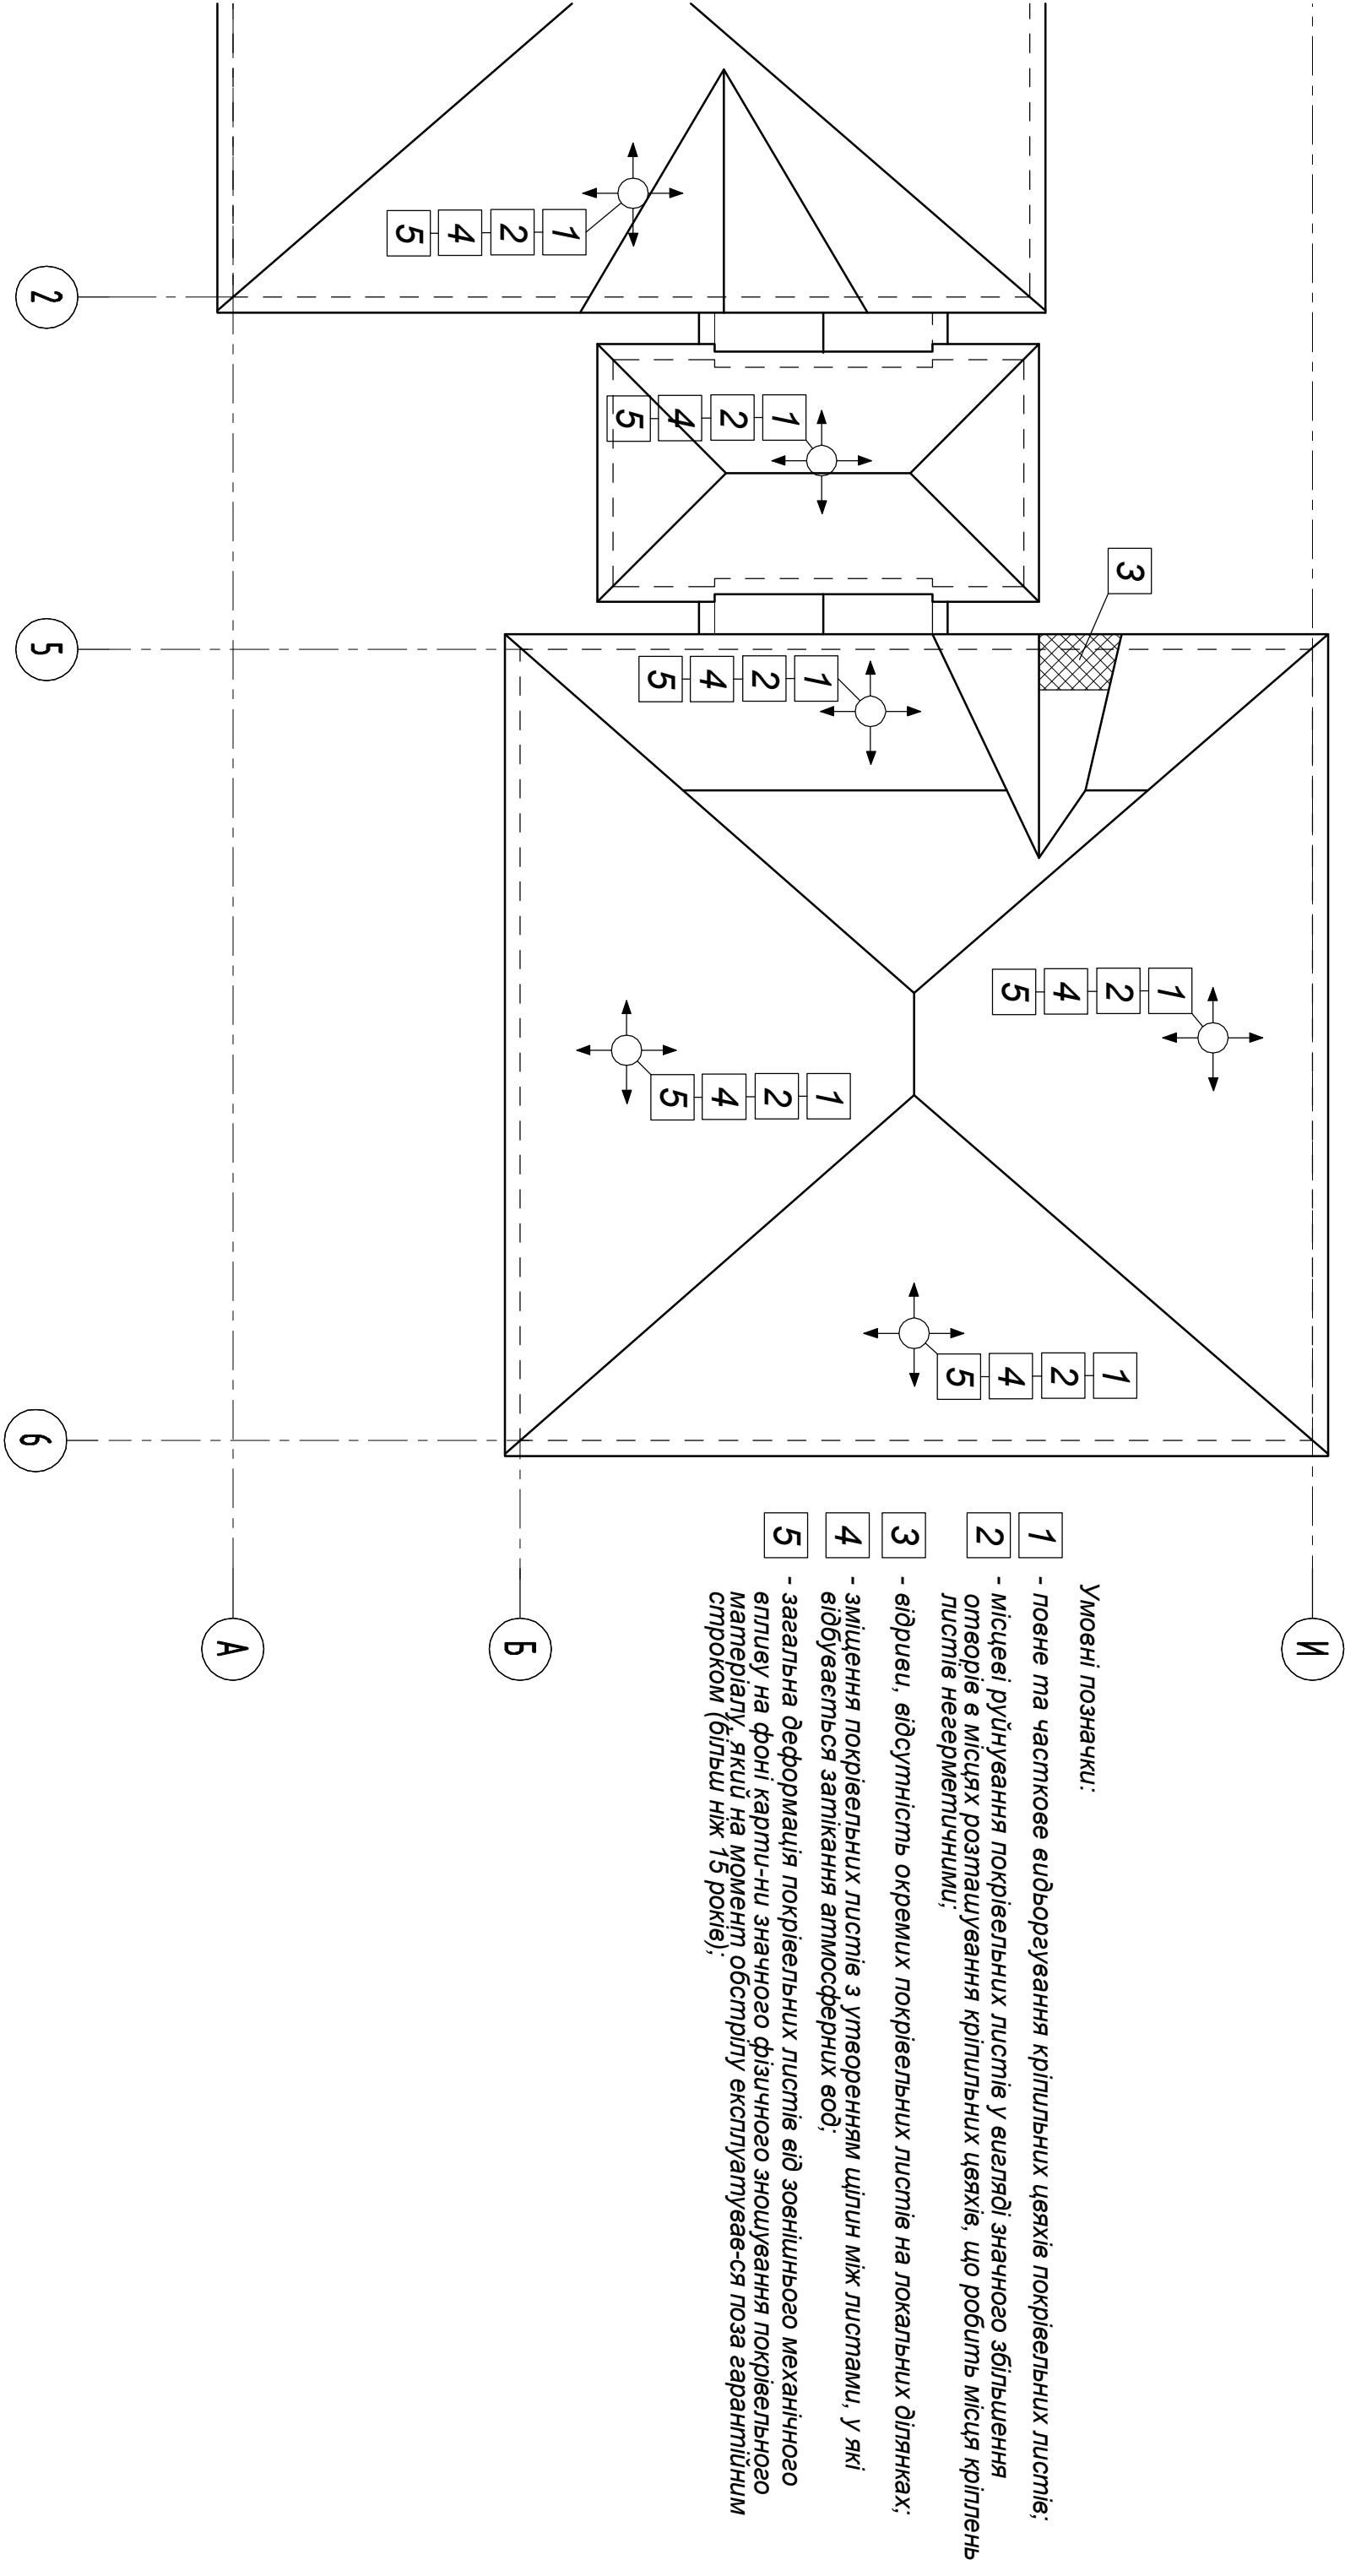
План - схема розташування пошкоджень покрівлі будівлі.
